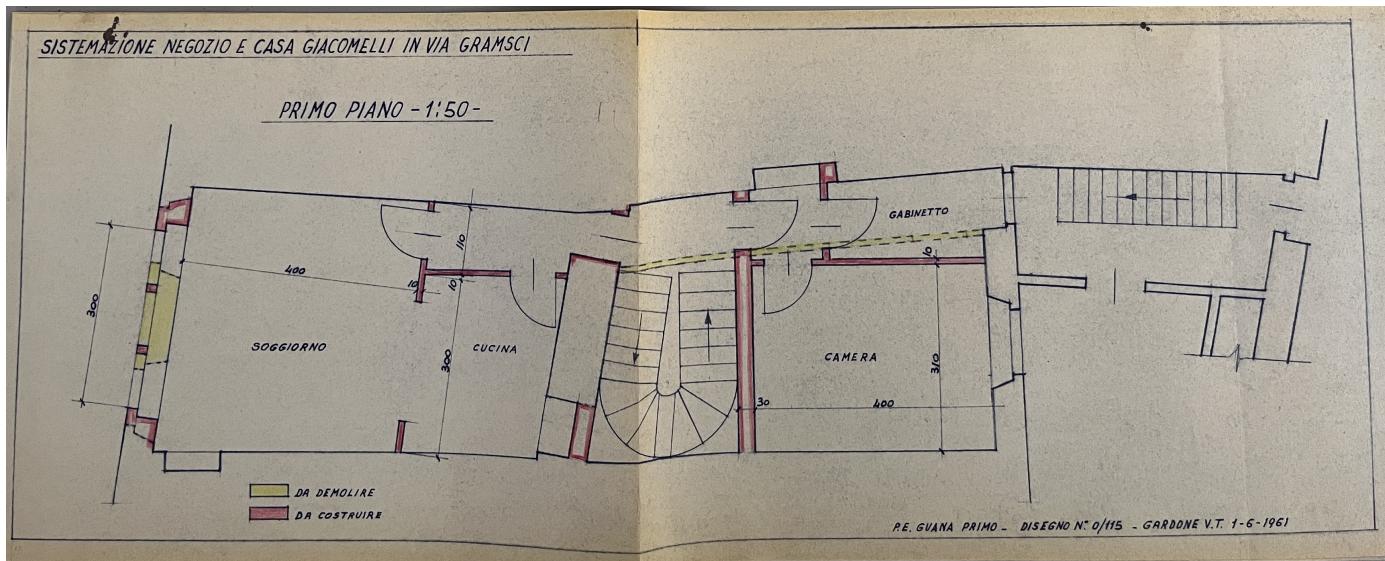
Estratto Licenza di costruzione N. 68 del 26.06.1961
